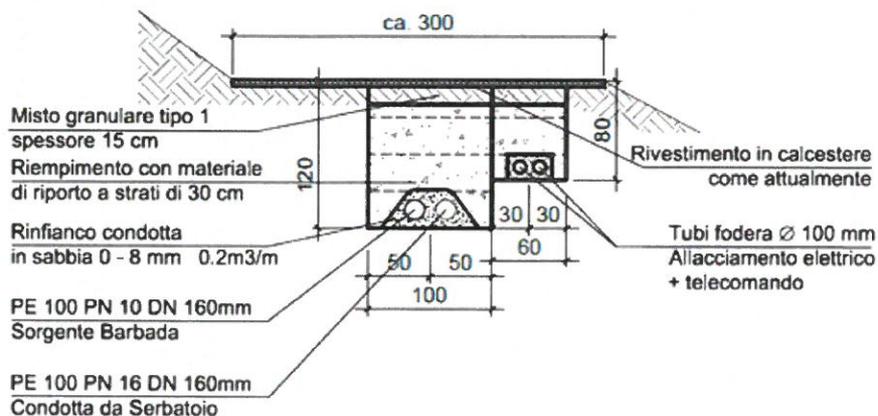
Sezione tipo lungo la strada ara Morèla dalla camera Barbada al serbatoio Foggia
